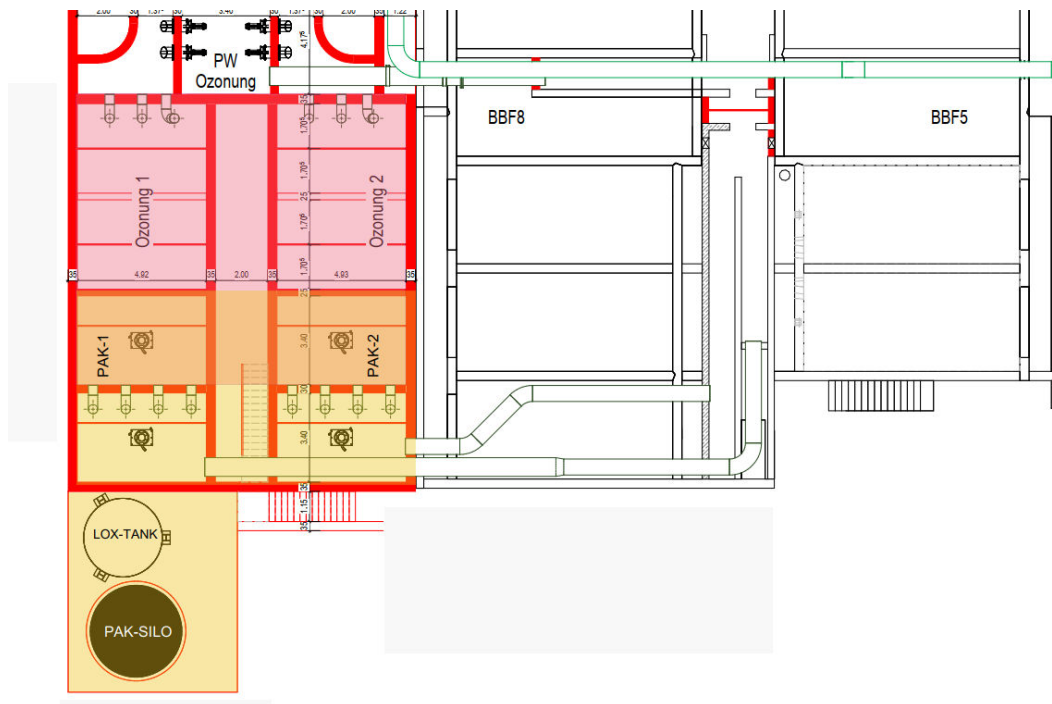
Ozonreaktoren (Grundriss)
